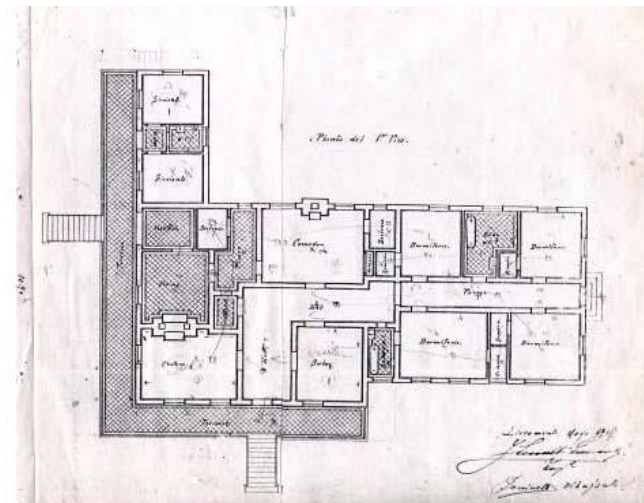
Planta Principal, desenhista Donineli, maio de 1917.
